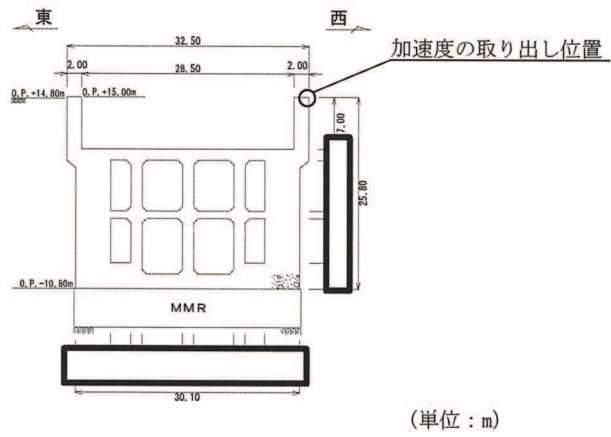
(2) 海水ポンプ室断面図 (スクリーンエリア) (A-A 断面)
